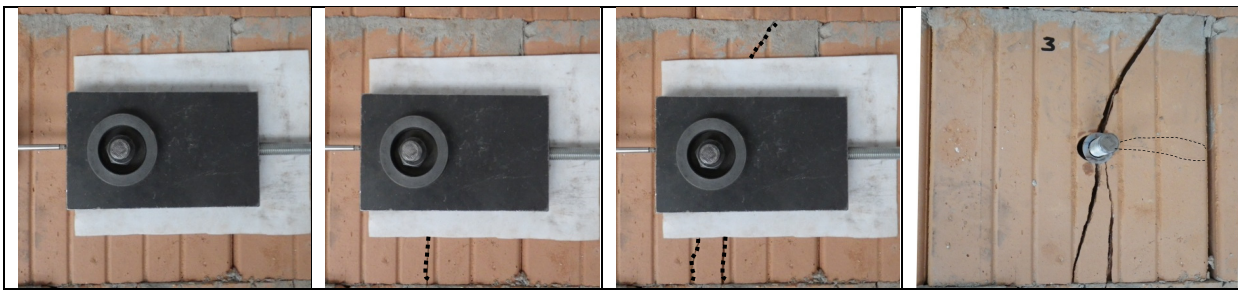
Typisches Risswachstum im Mauerwerk bei Querlastversuchen
